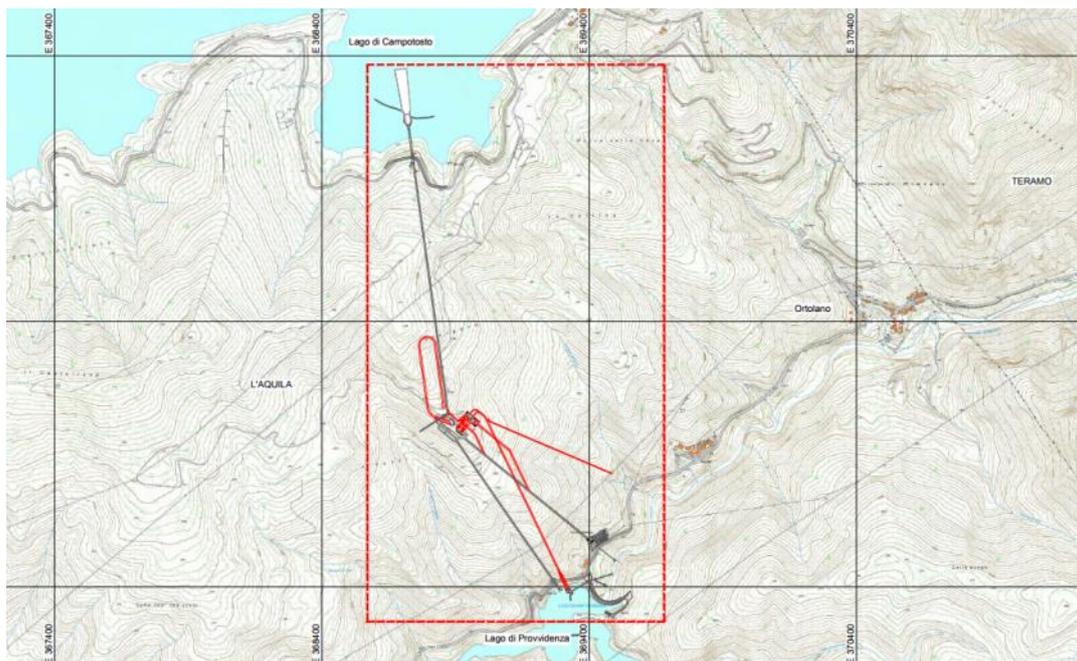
Estratto planimetrico generale delle opere in progetto (in rosso) e delle strutture esistenti (in grigio)
